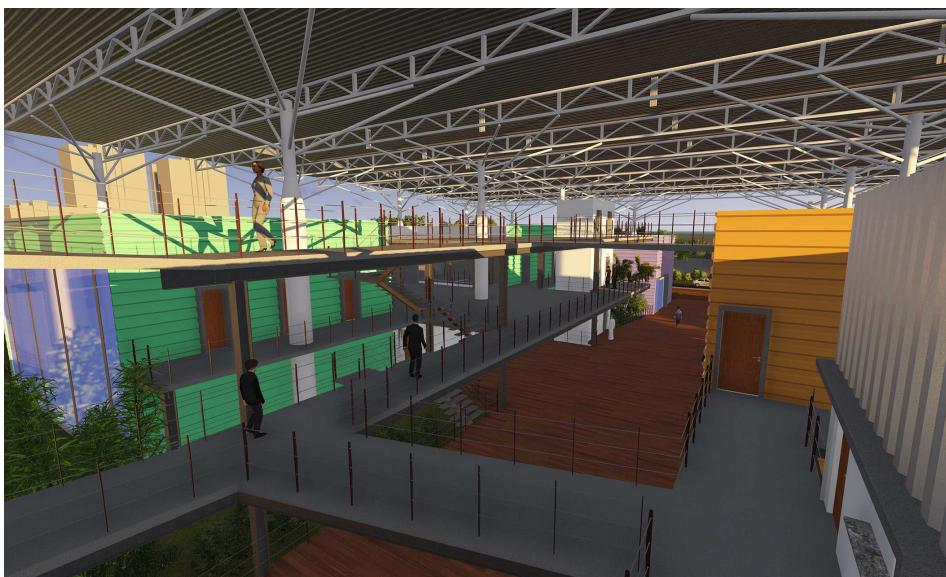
Vista da circulações e passarelas da escola da construção (sup.).
